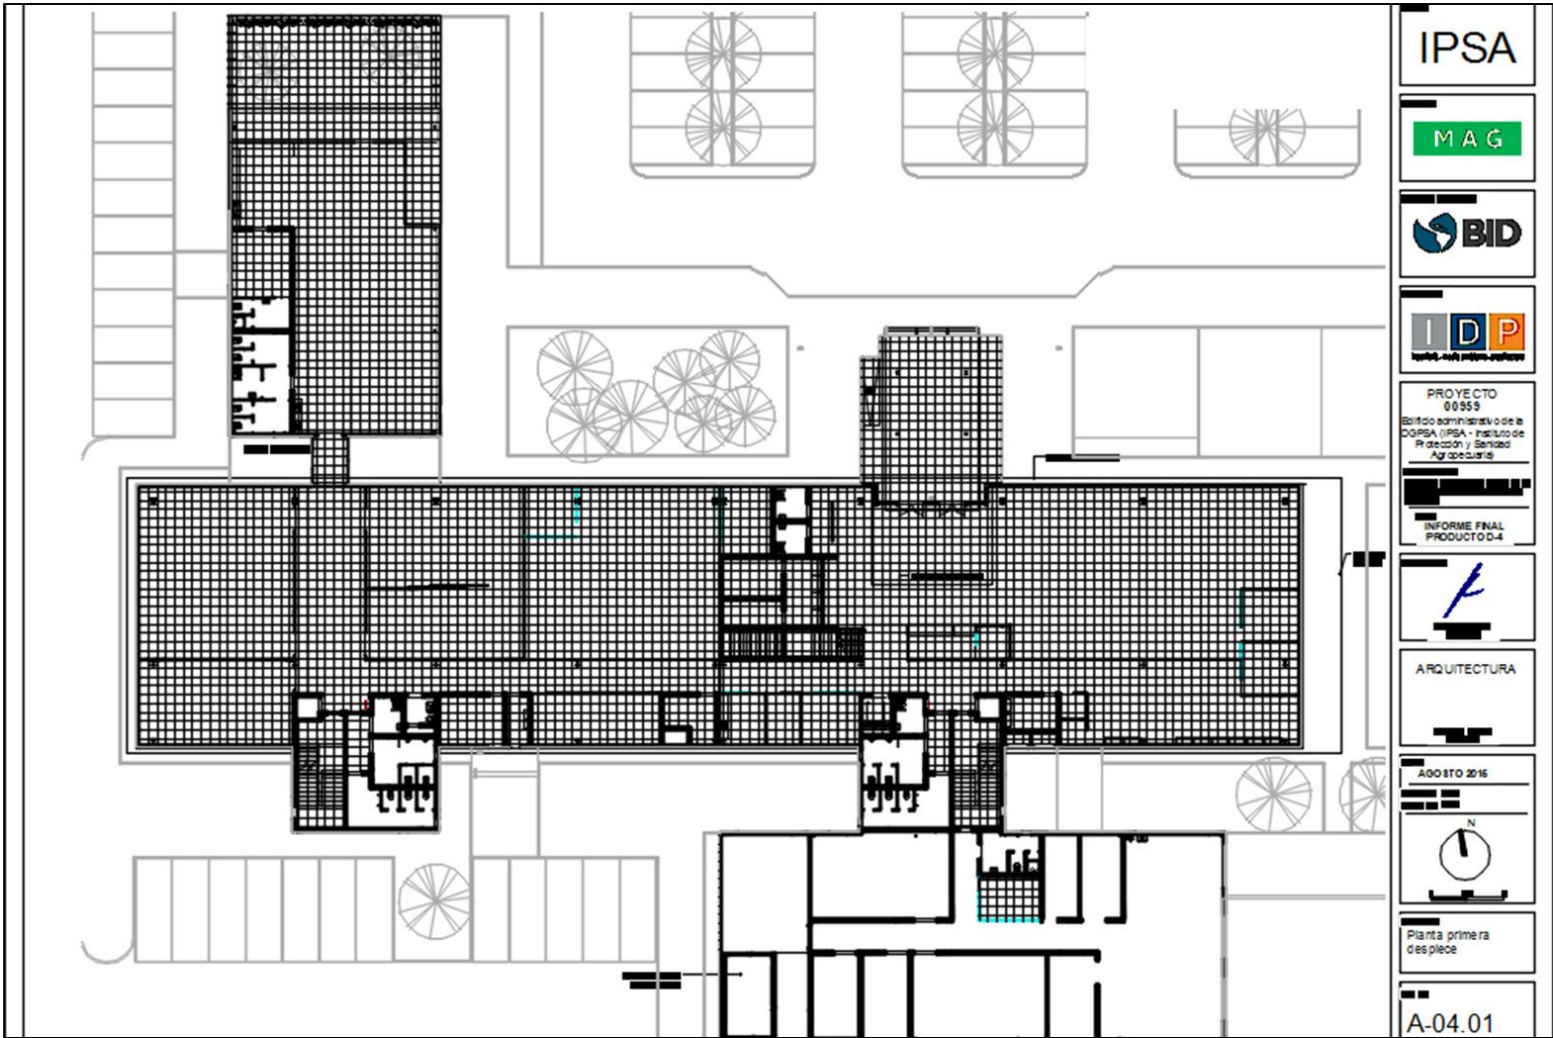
Lamina de planta arquitectónica de piso 1era planta propuesta 1
